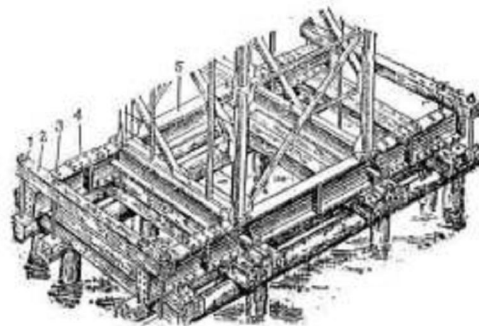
Крепление нижнего ригеля к свайному основанию:
